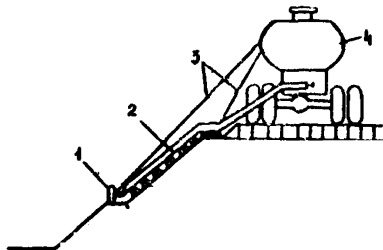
Схема установки автогудронатора при розливе нефти: 1-опорное пневмоколесо; 2-распределительная труба; 3-растяжка; 4-автогудронатор
